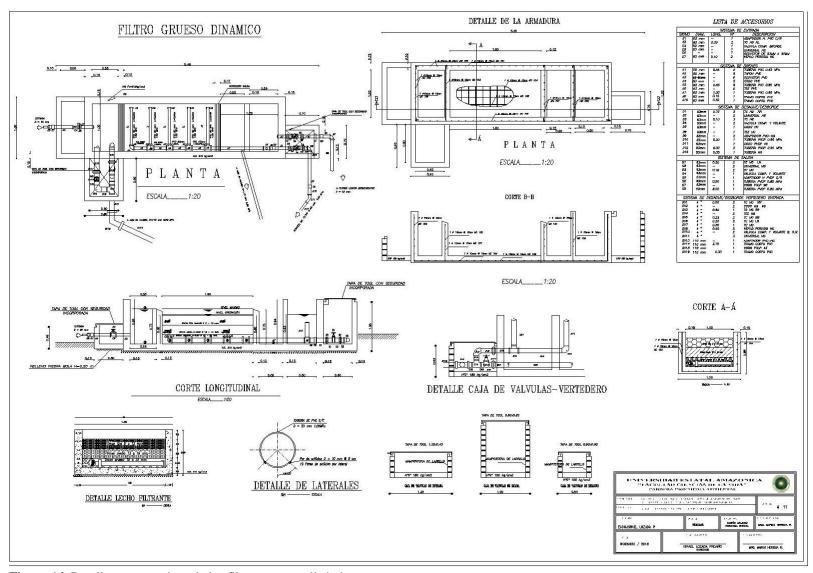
Detalles constructivos de los filtros gruesos dinámicos.
